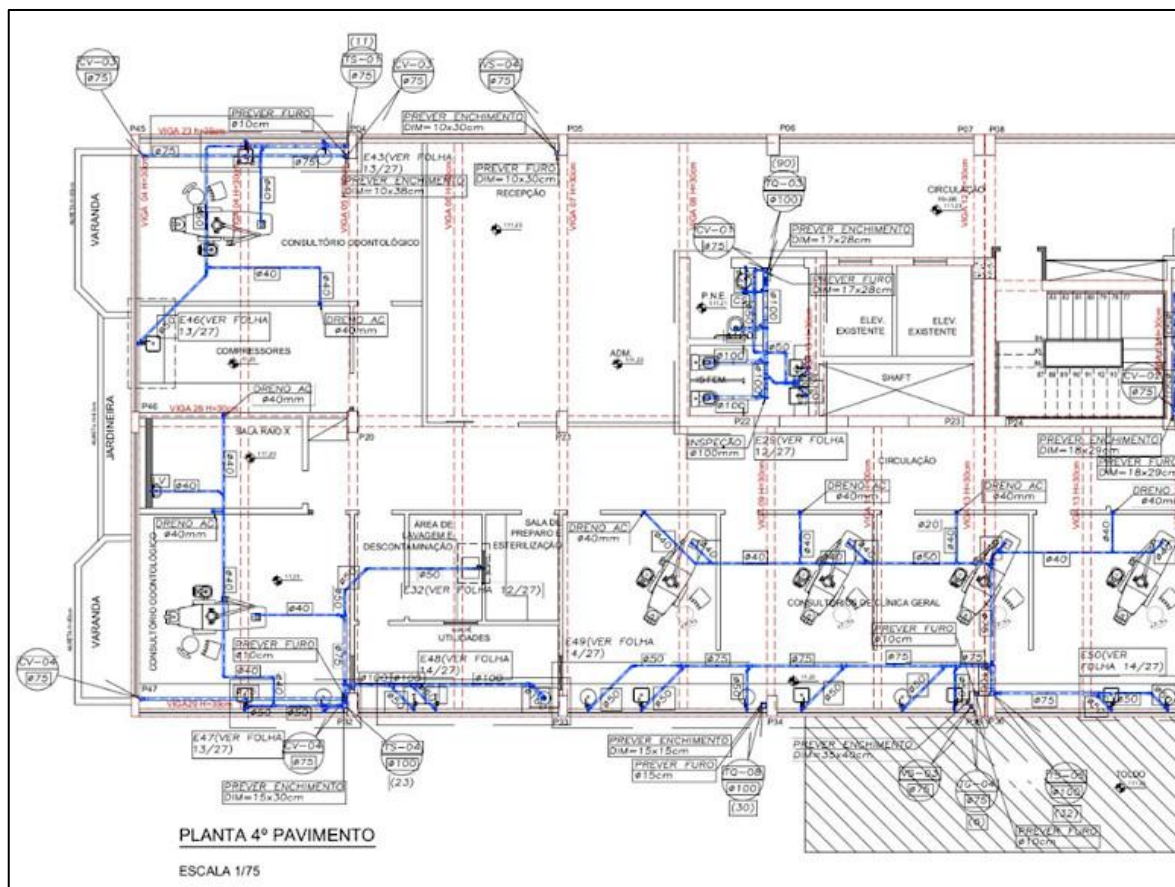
Planta 4º pavimento – redes de tubulações juntas e cruzando as vigas.
